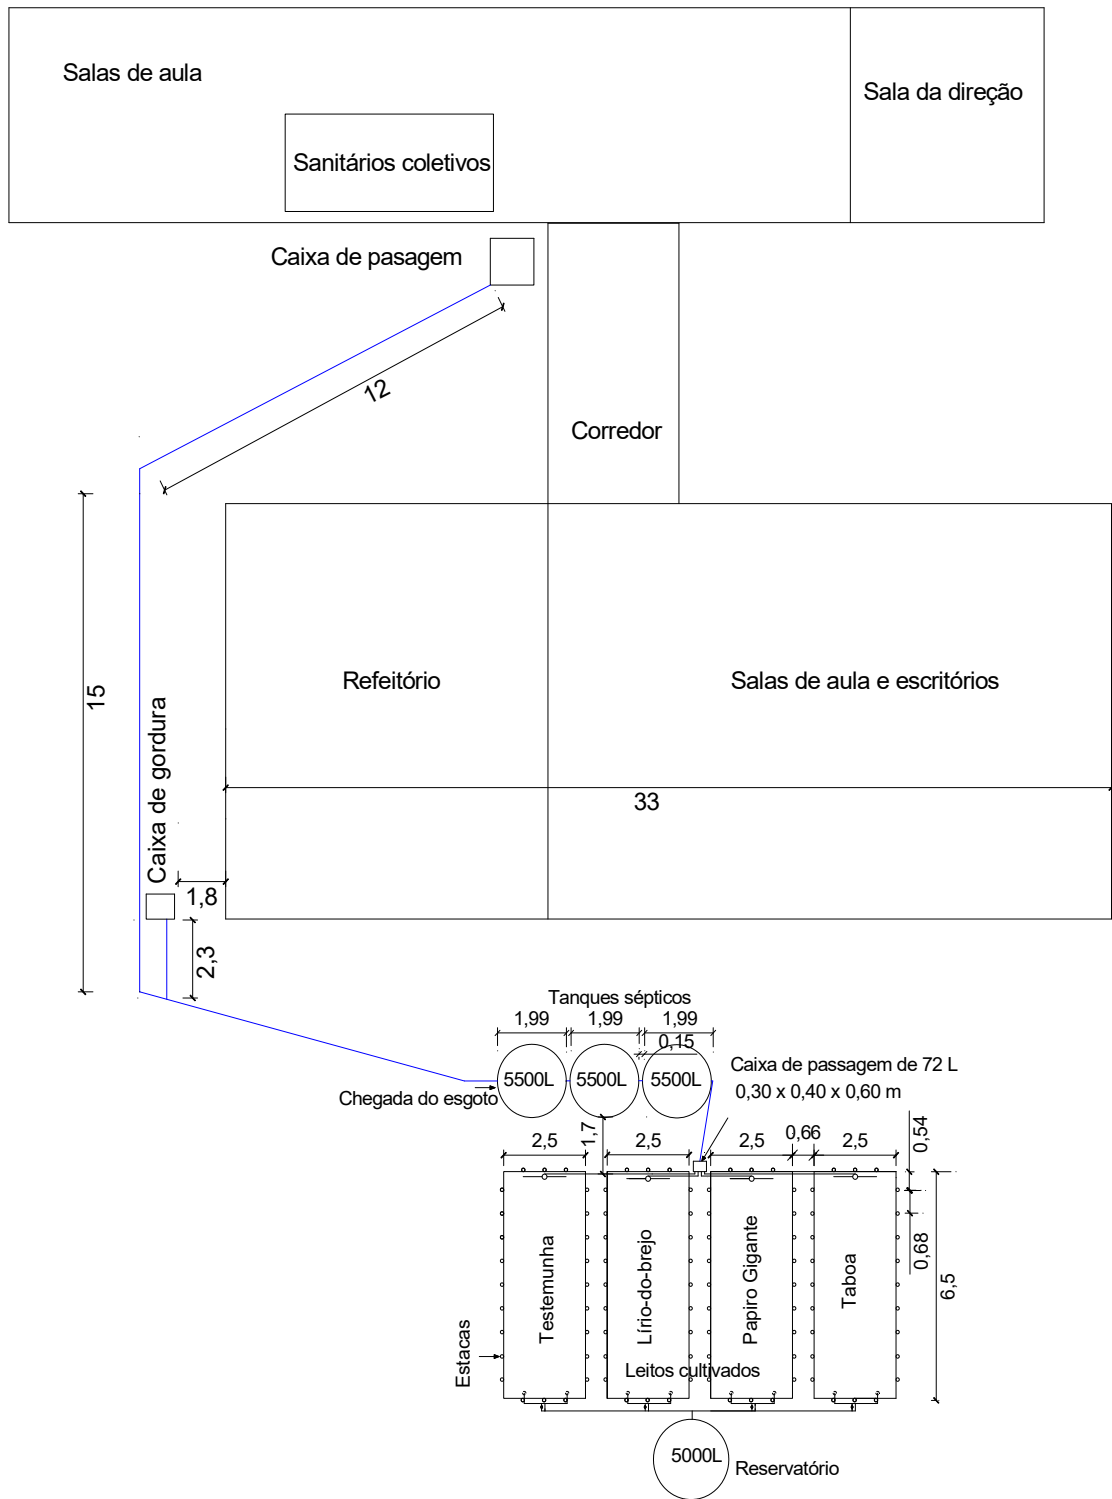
Planta baixa da estação de tratamento de esgoto (ETE/FAL/UnB).
